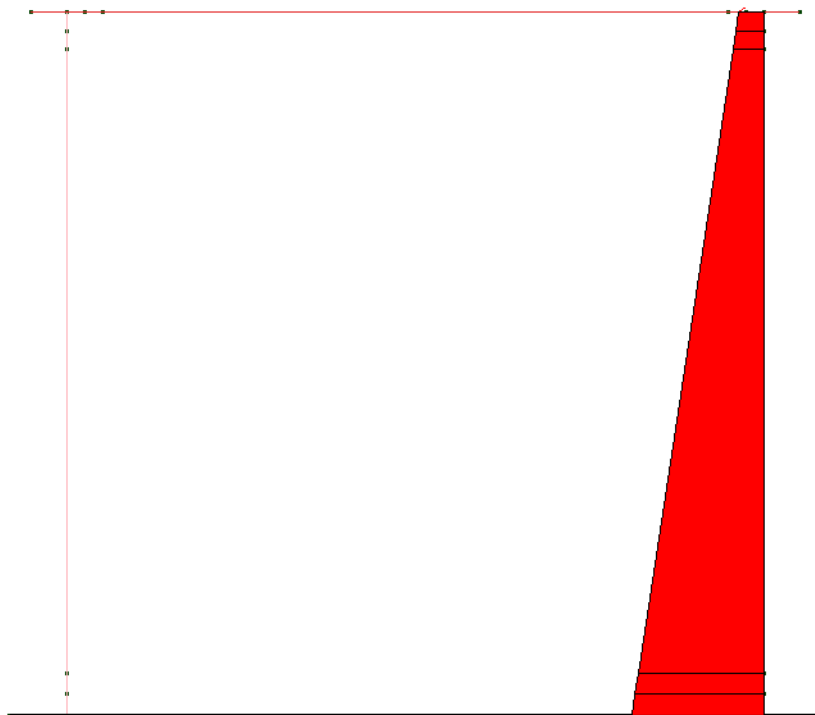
SPINTA A RIPOSO DELLE TERRE SUL PIEDRITTO DESTRO (CDC 4)
